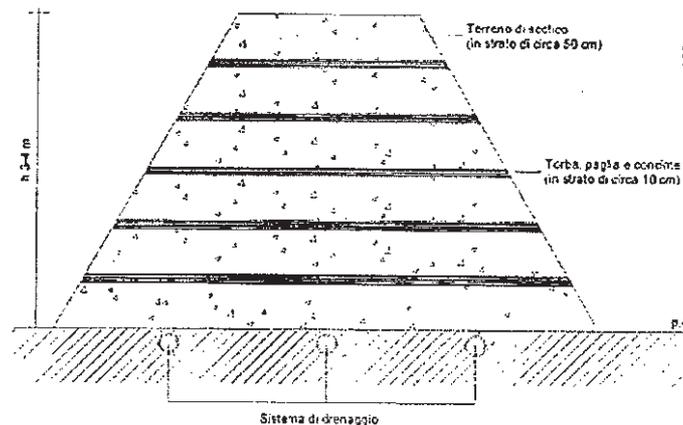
/1: sezione tipo delle dune di stoccaggio dello scotico
